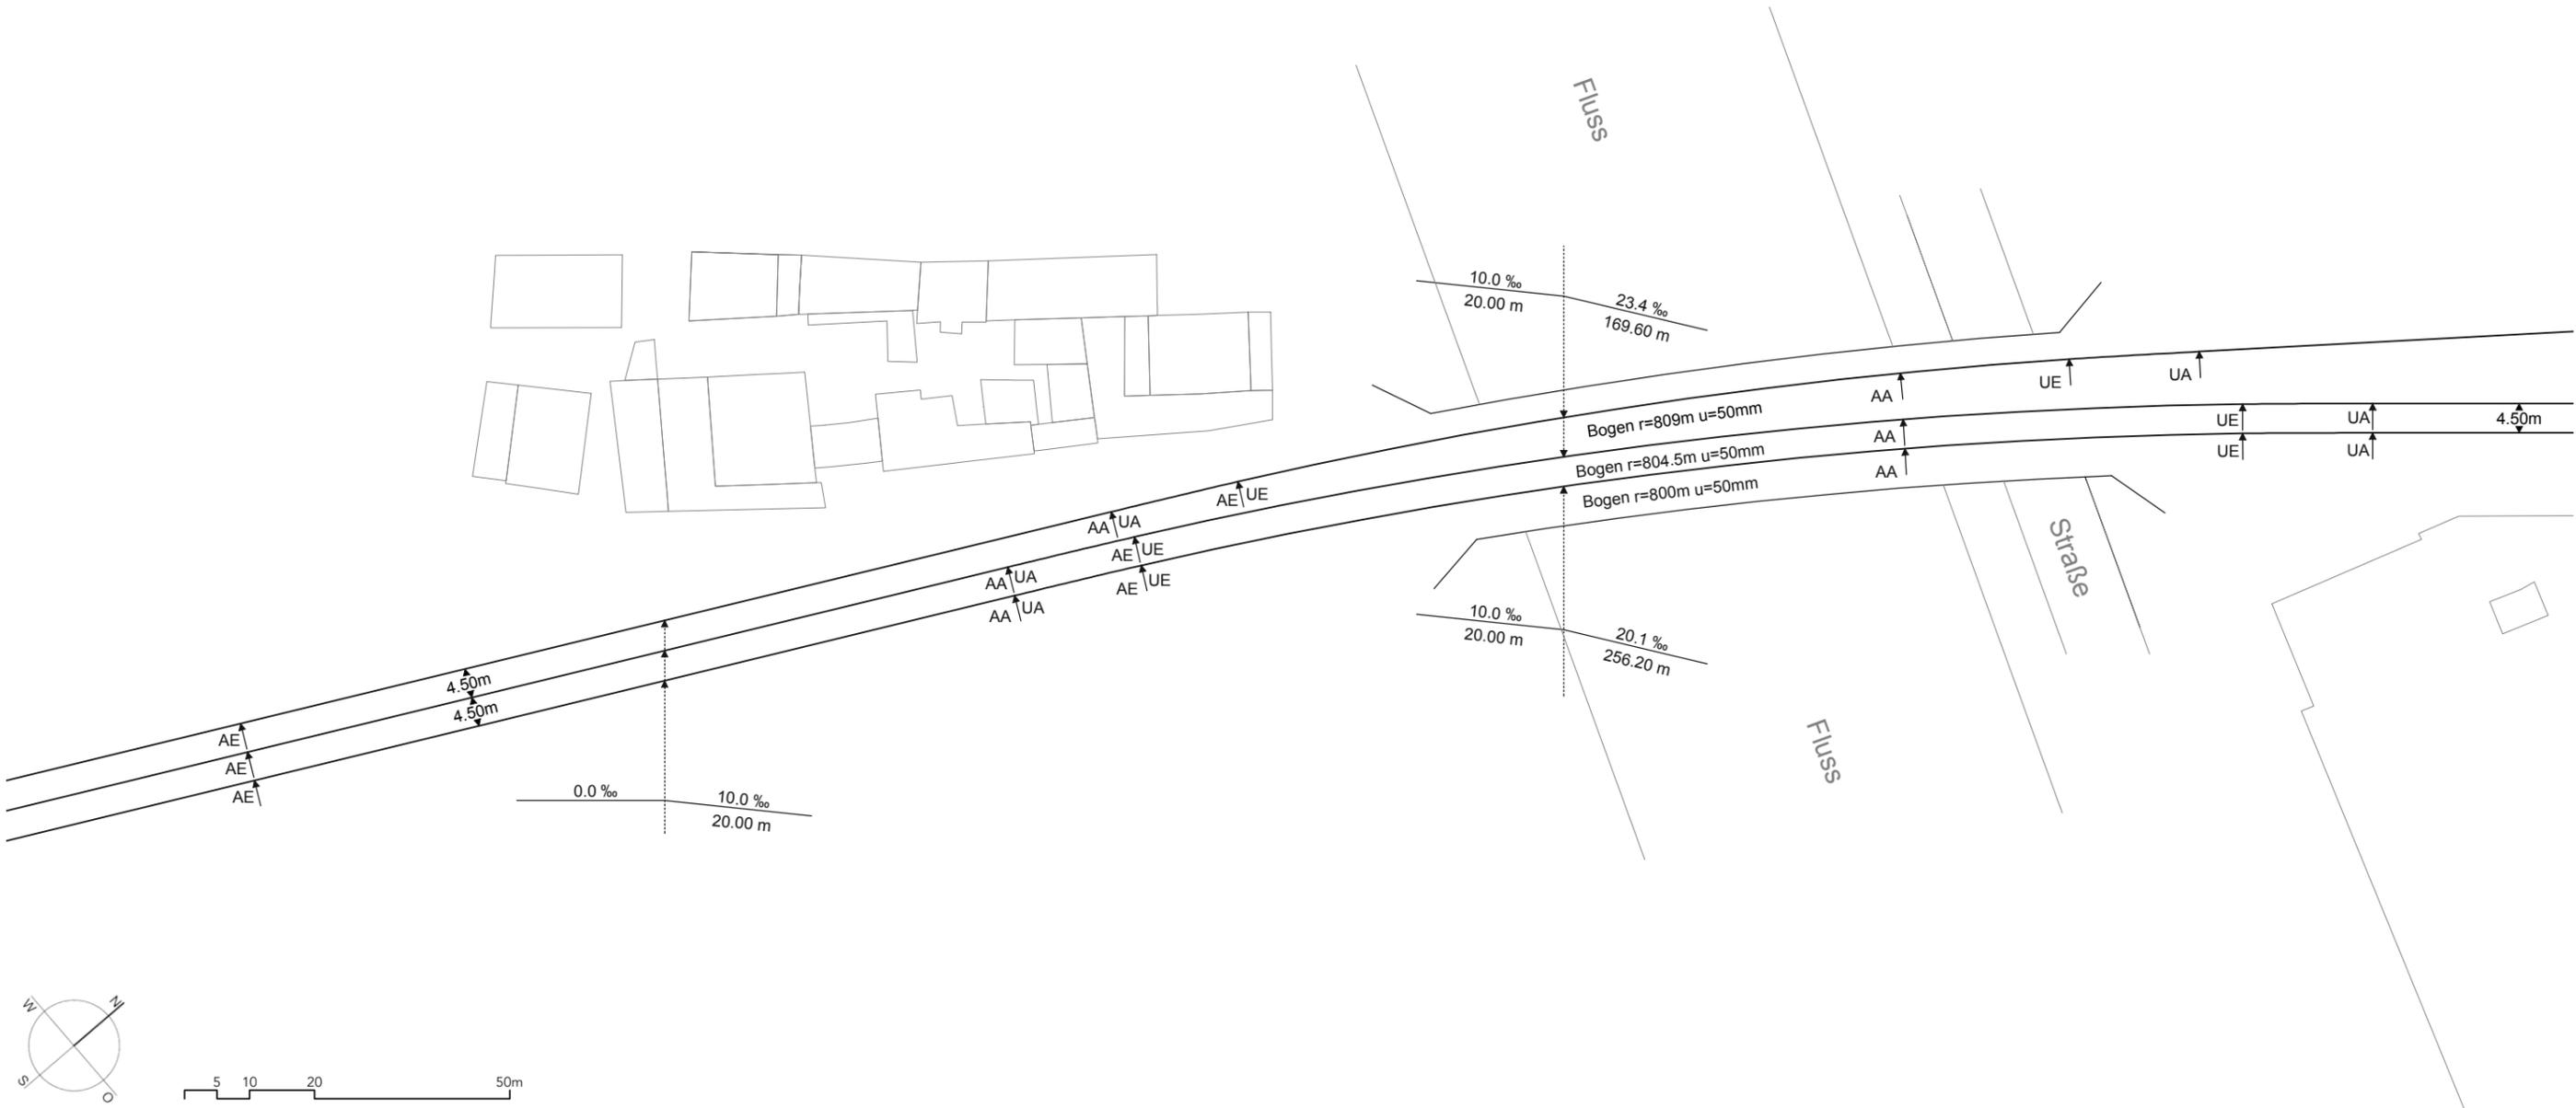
Lageplan Schienennetz Übersichtsplan 1:5000
